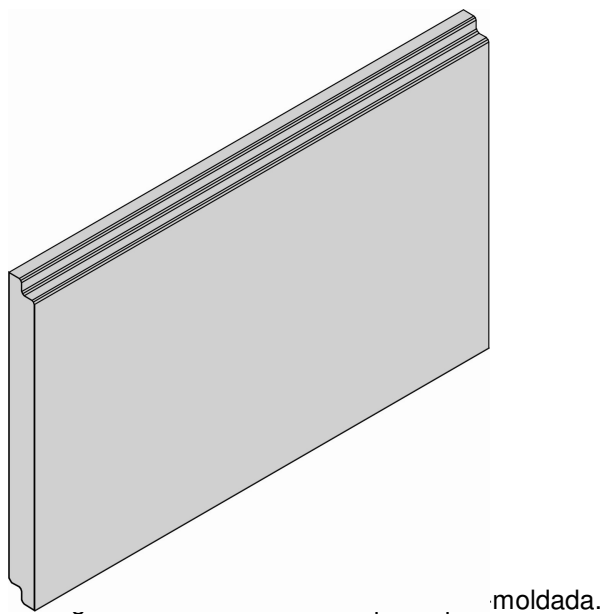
Placas pré-moldadas de 5 cm de espessura.
